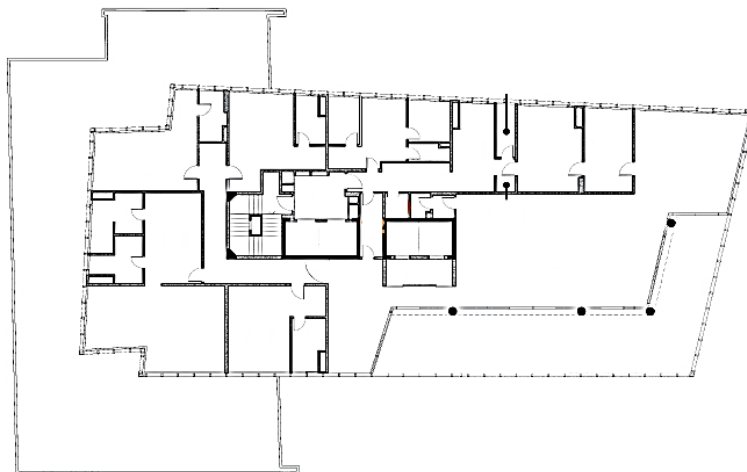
Ed. Vitra, pavimento tipo composto por uma unidade.
